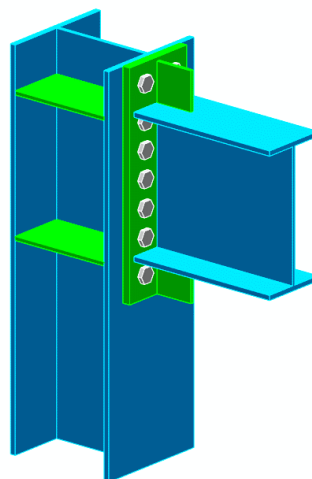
Vue 3D de l'assemblage poutre principal poteau
